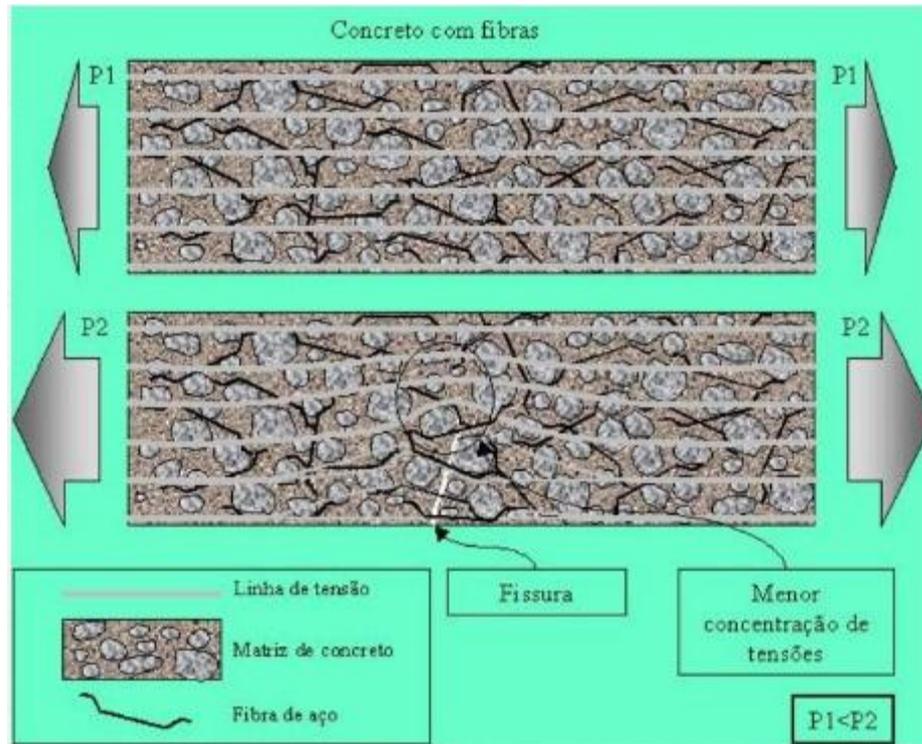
Mecanismo de controle de propagação das fissuras
